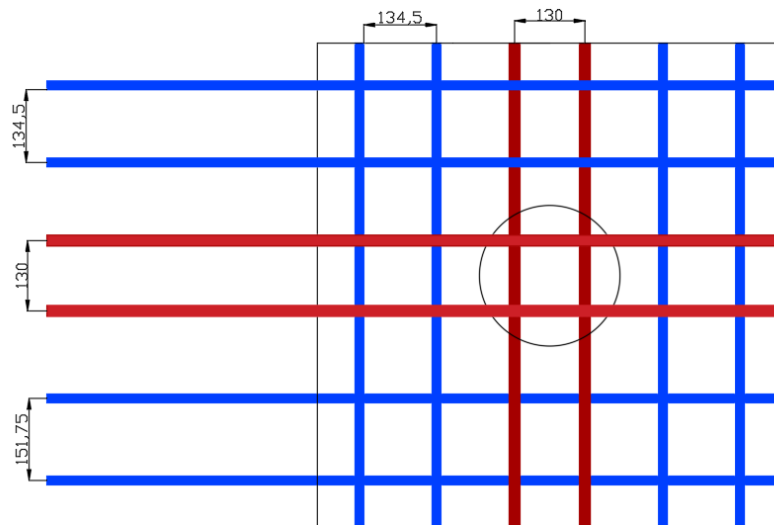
Armadura Pila 1, Transversal y longitudinal, Espaciado entre las diferentes barras
